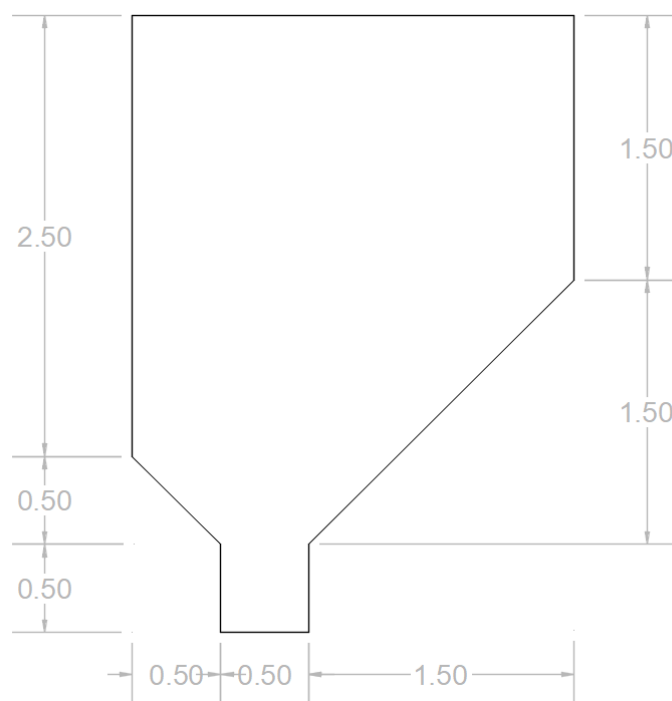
Sección dimensionamiento desarenador-desengrasador
